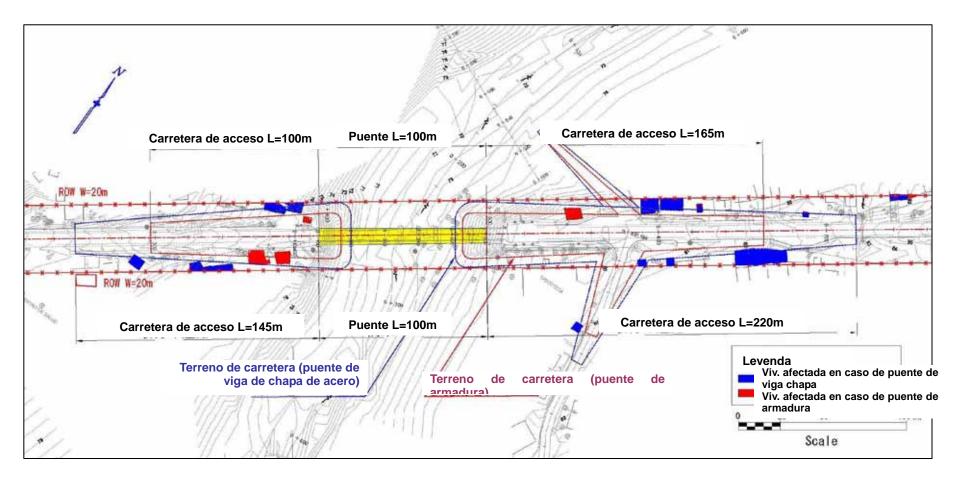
Ancho de Terreno Requerido según Tipo de Puente y Viviendas Afectadas (Puente Las Banderas)
